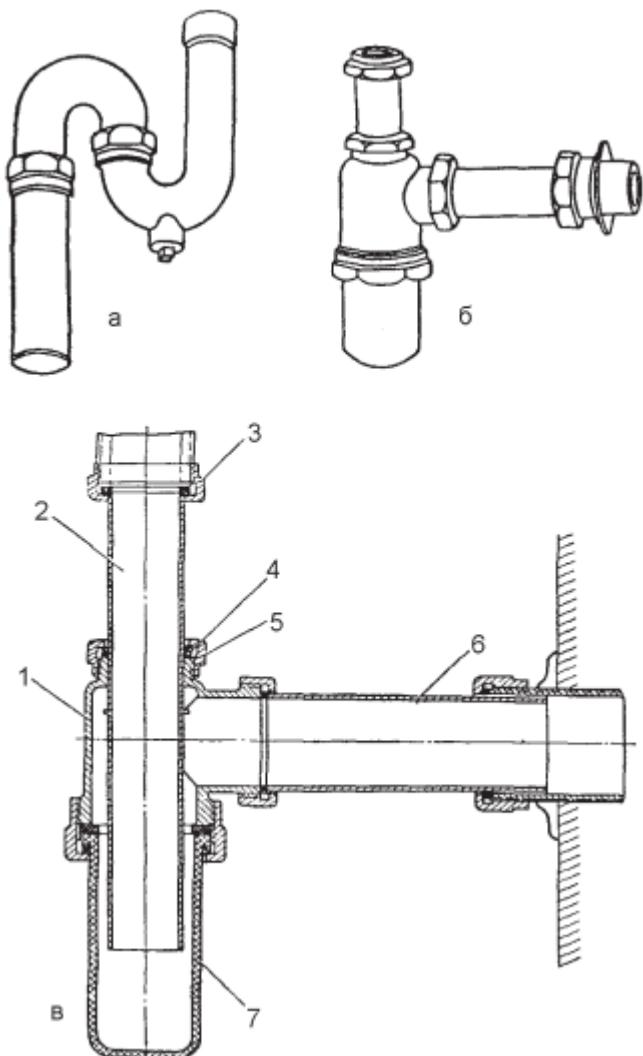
Сифоны: а – двухоборотный; б – бутылочный с боковым выпуском; в – внутреннее устройство бутылочного сифона
